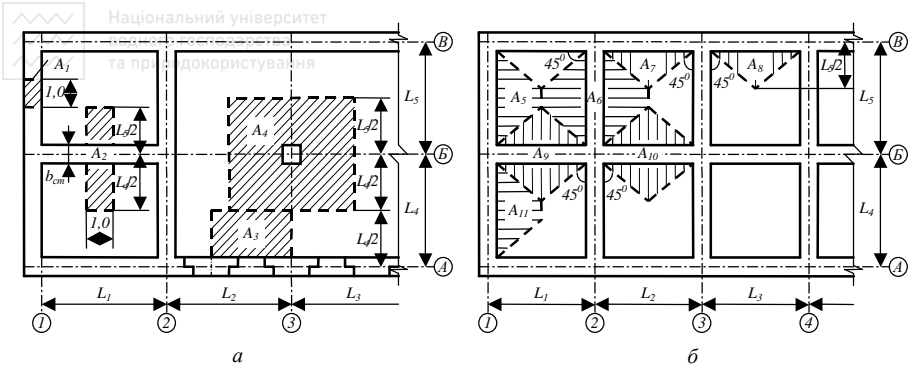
Схема підрахунку навантаження на відповідні вантажні площі, що передають навантаження на уступ фундаменту: *a* - для випадку поздовжніх несучих стін; *б* - для випадку поздовжніх і поперечних несучих стін
